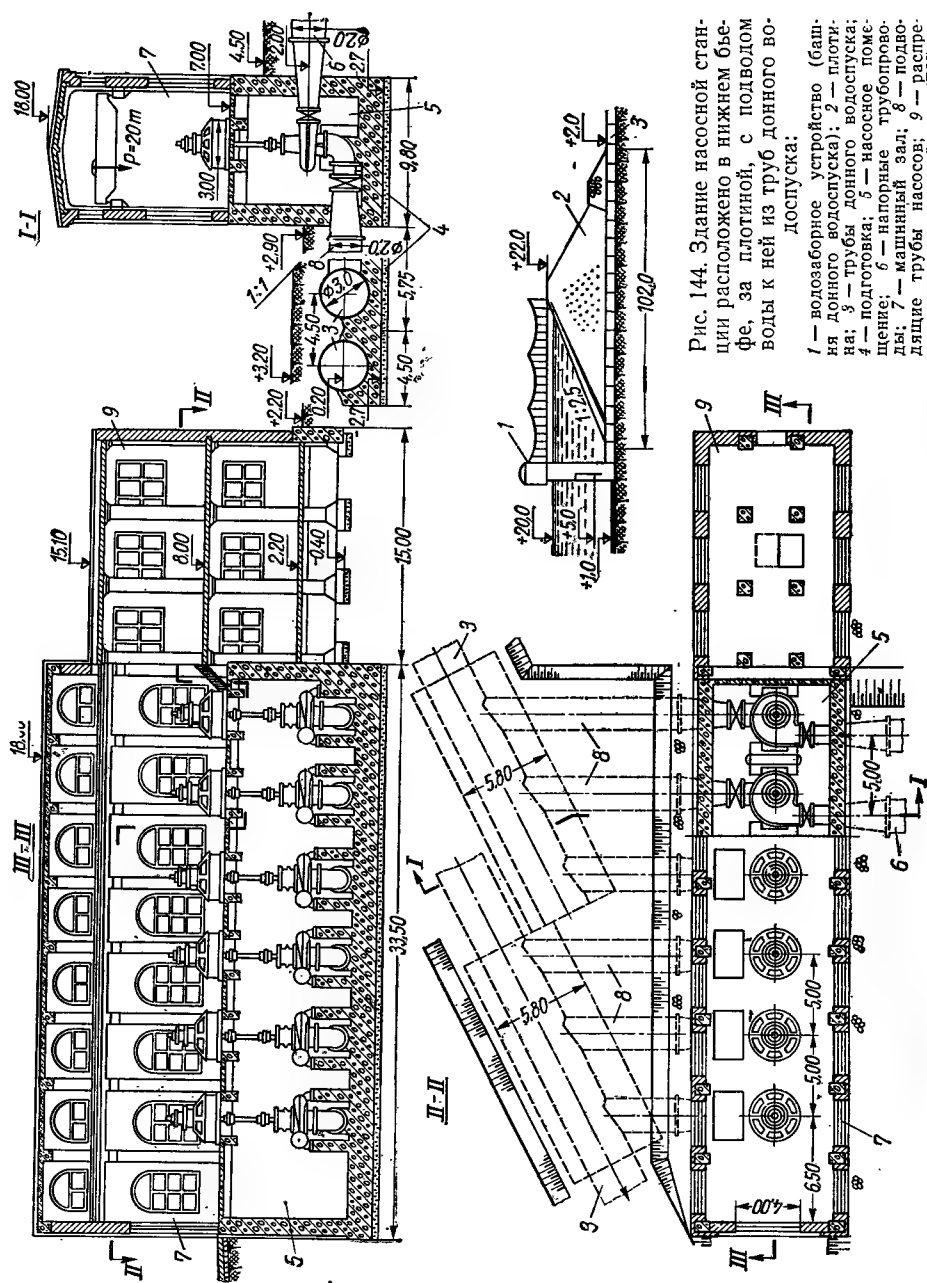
Здание насосной станции расположено в нижнем бьефе, за плотиной, с подводом воды к ней из труб донного водоспуска:
